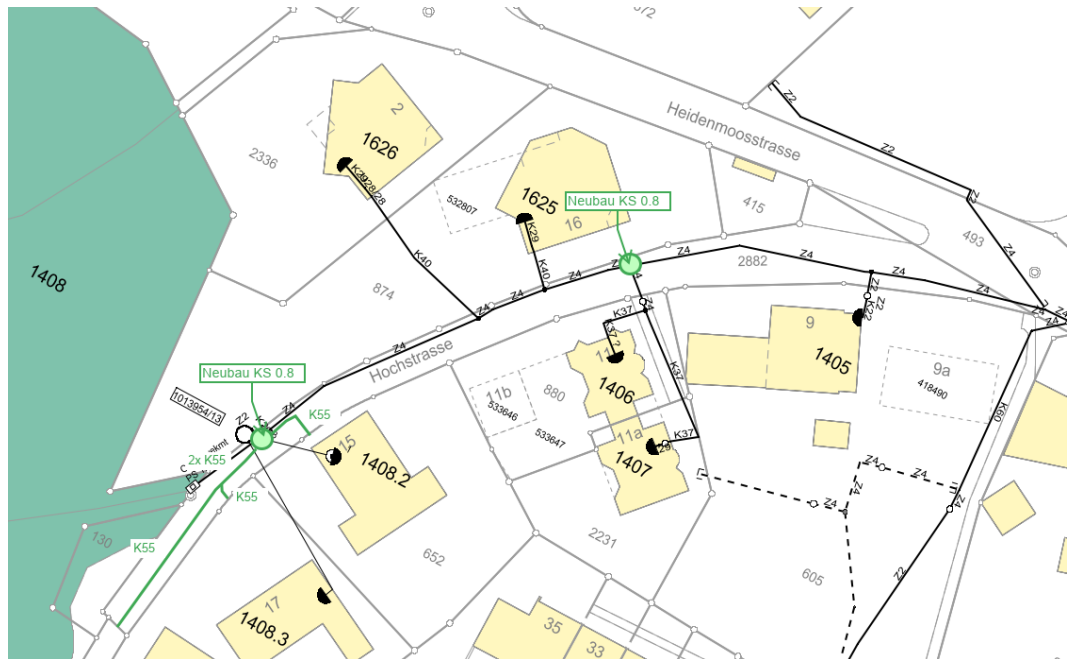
Ausschnitt Situationsplan Swisscom Bereich Hochstrasse
